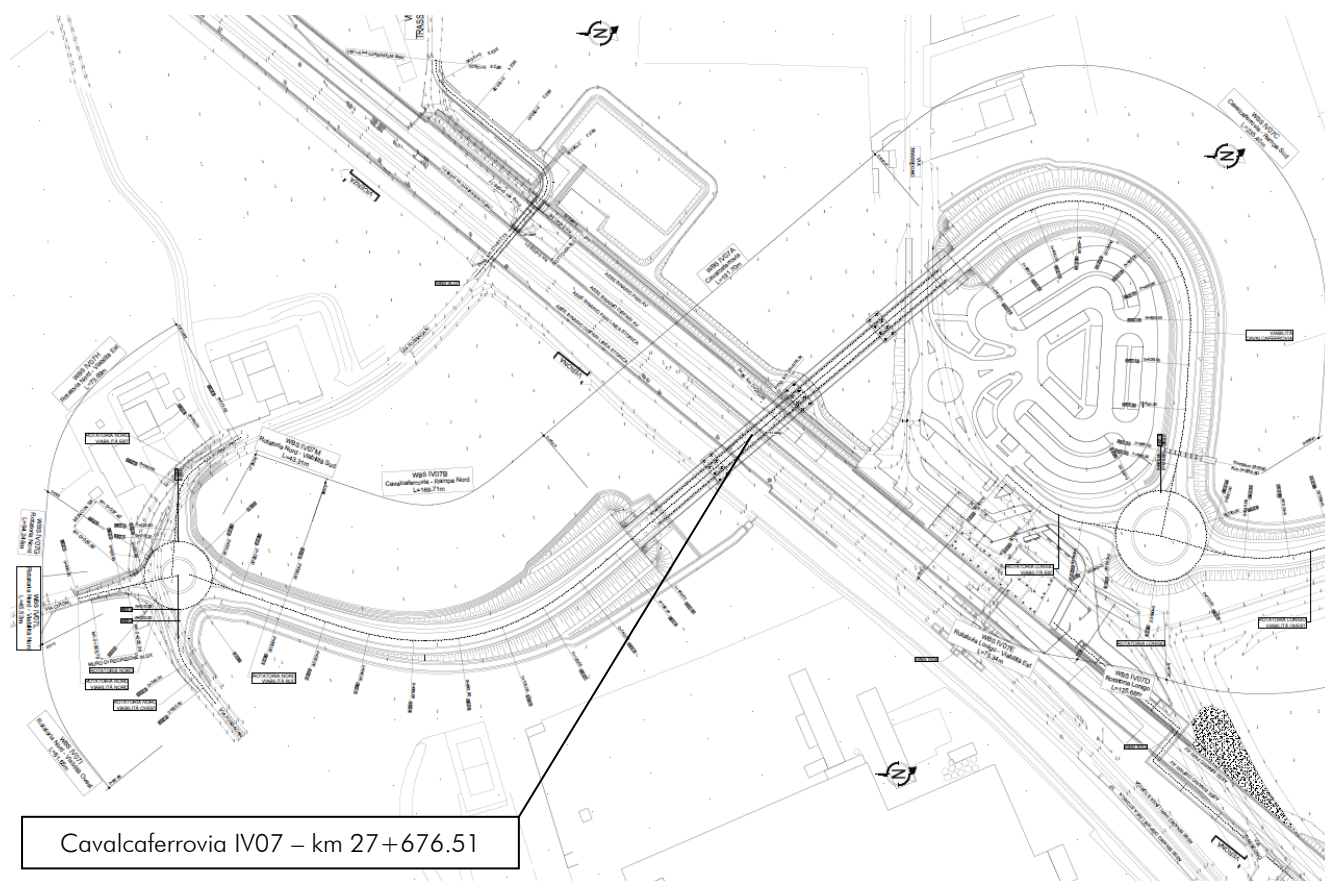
Stralcio planimetrico – Ubicazione Cavalcaferrovia IV07
